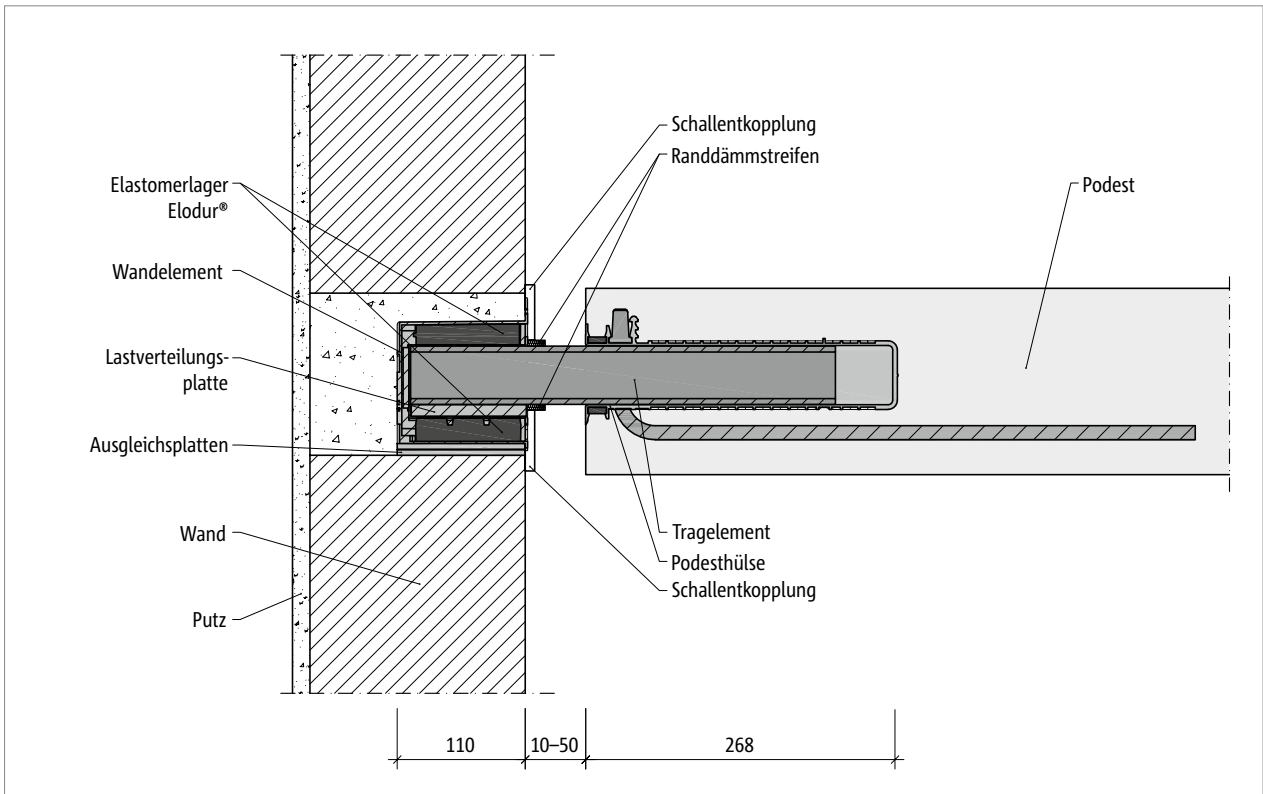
Schöck Tronsole® Typ P: Einbauschnitt mit Elementpodest und Luftfuge
